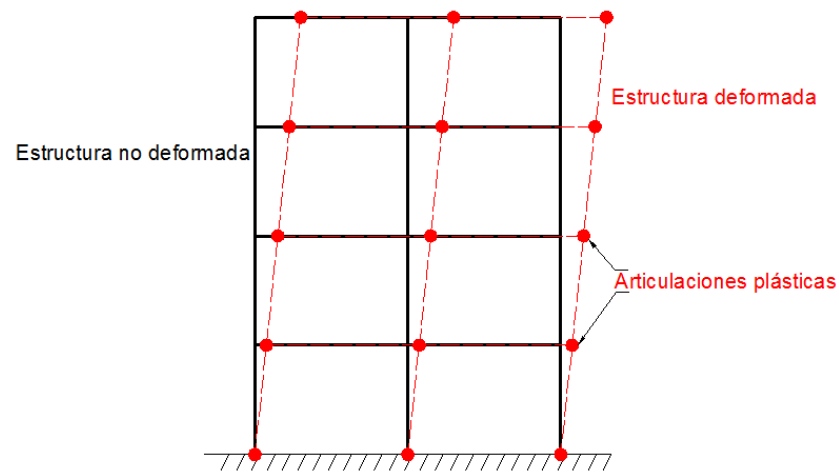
Mecanismo idealizado de desplazamientos laterales, para columnas con criterio de diseño columna fuerte-viga débil.
